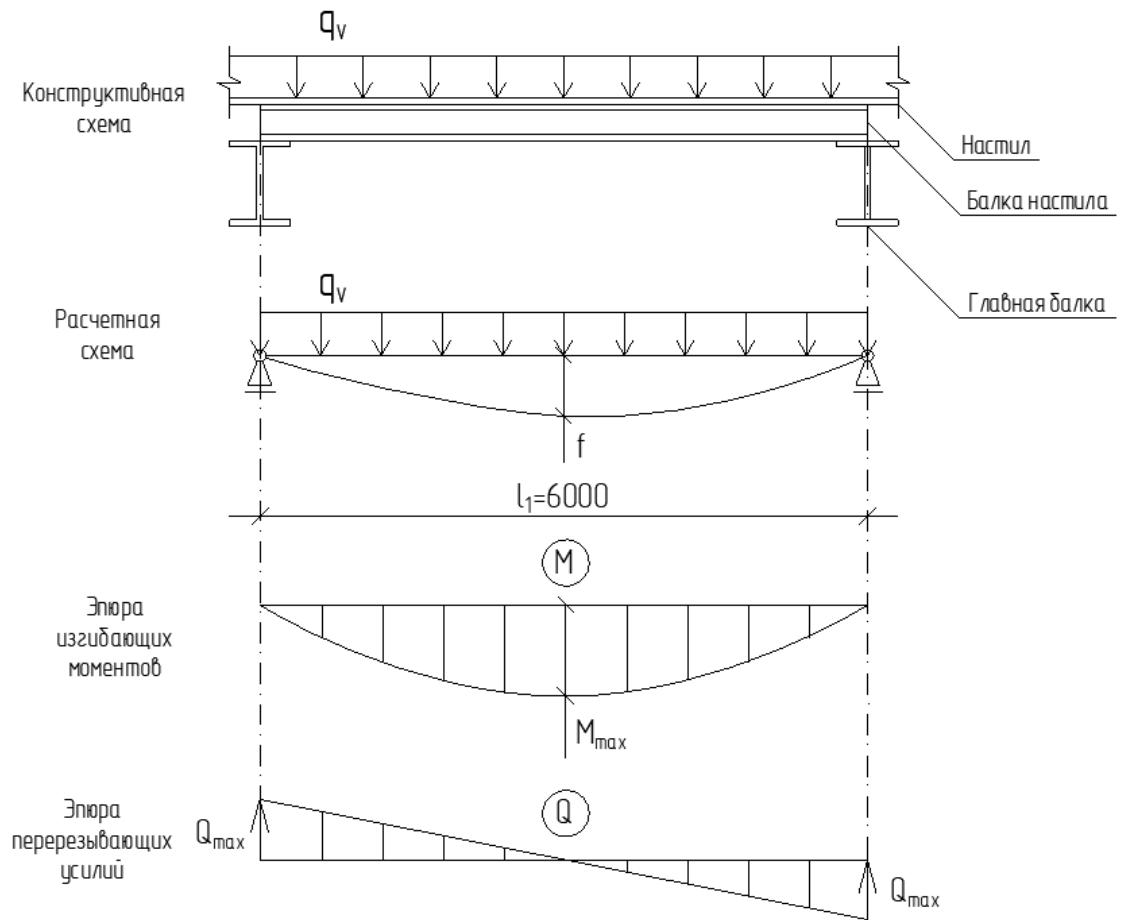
Расчетная и конструктивная схемы балок настила
